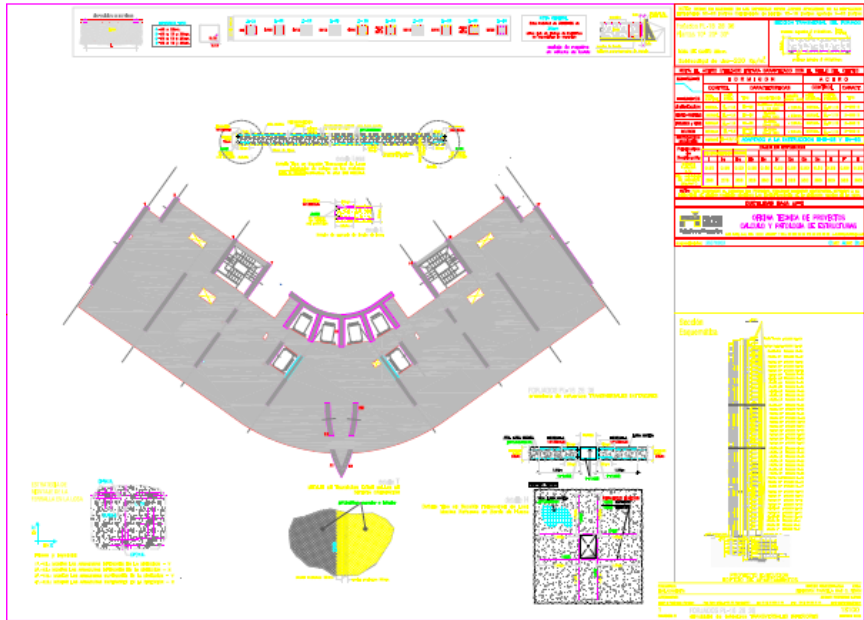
Plano estructura planta técnica.2005.Edifesa
